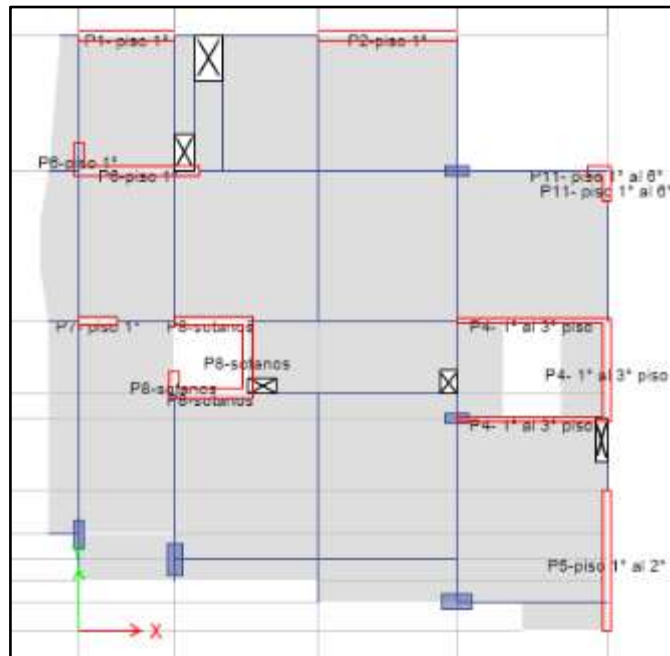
Vista en planta de M1 (piso 1° al 6°) en ETABS
